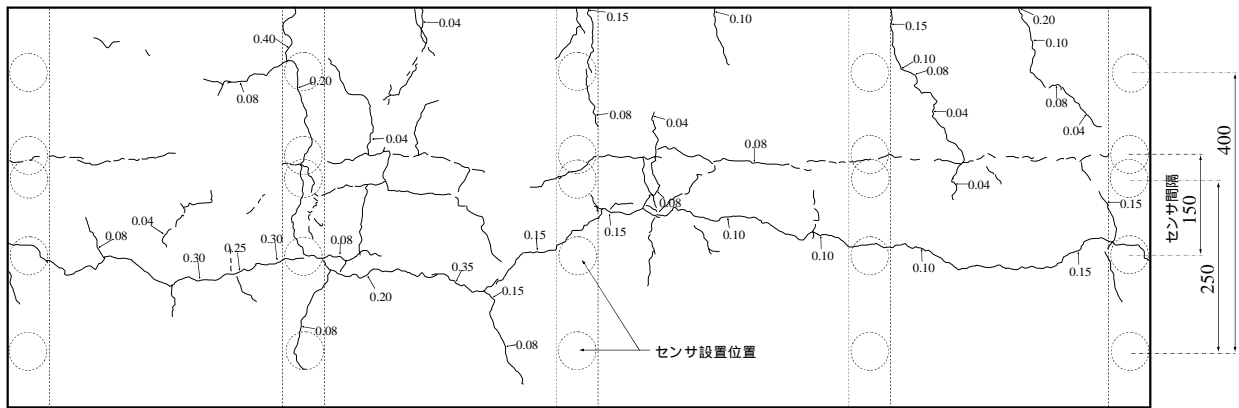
供試体のひび割れ発生状況展開図 (mm)
